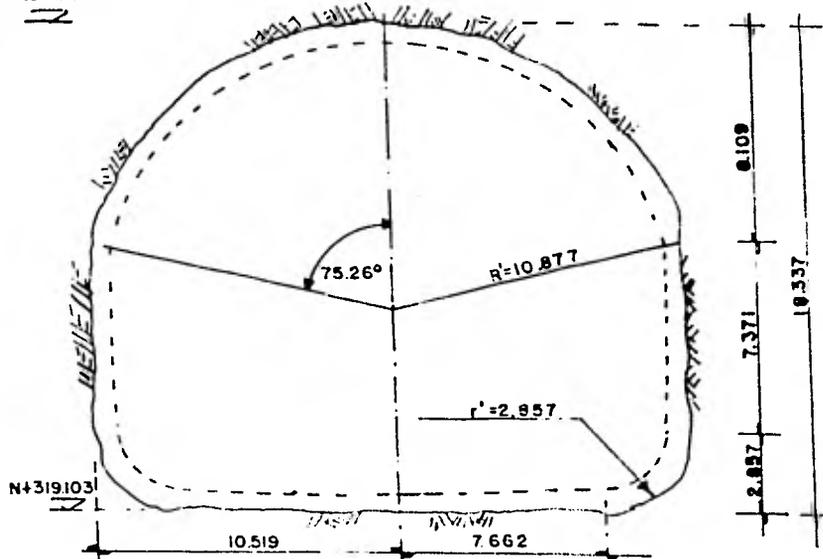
SECCION EN EL CADENAMIENTO 0+149.718
